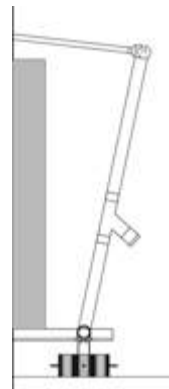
Corte esquemático de estructura para cubierta. Fuente: Elaboración en equipo.
